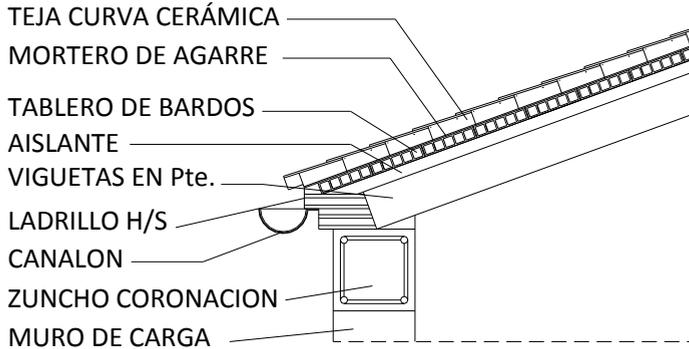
Detalle esquemático de la cubierta inclinada tipo de la vivienda en su estado reformado con la adición del aislamiento térmico.
